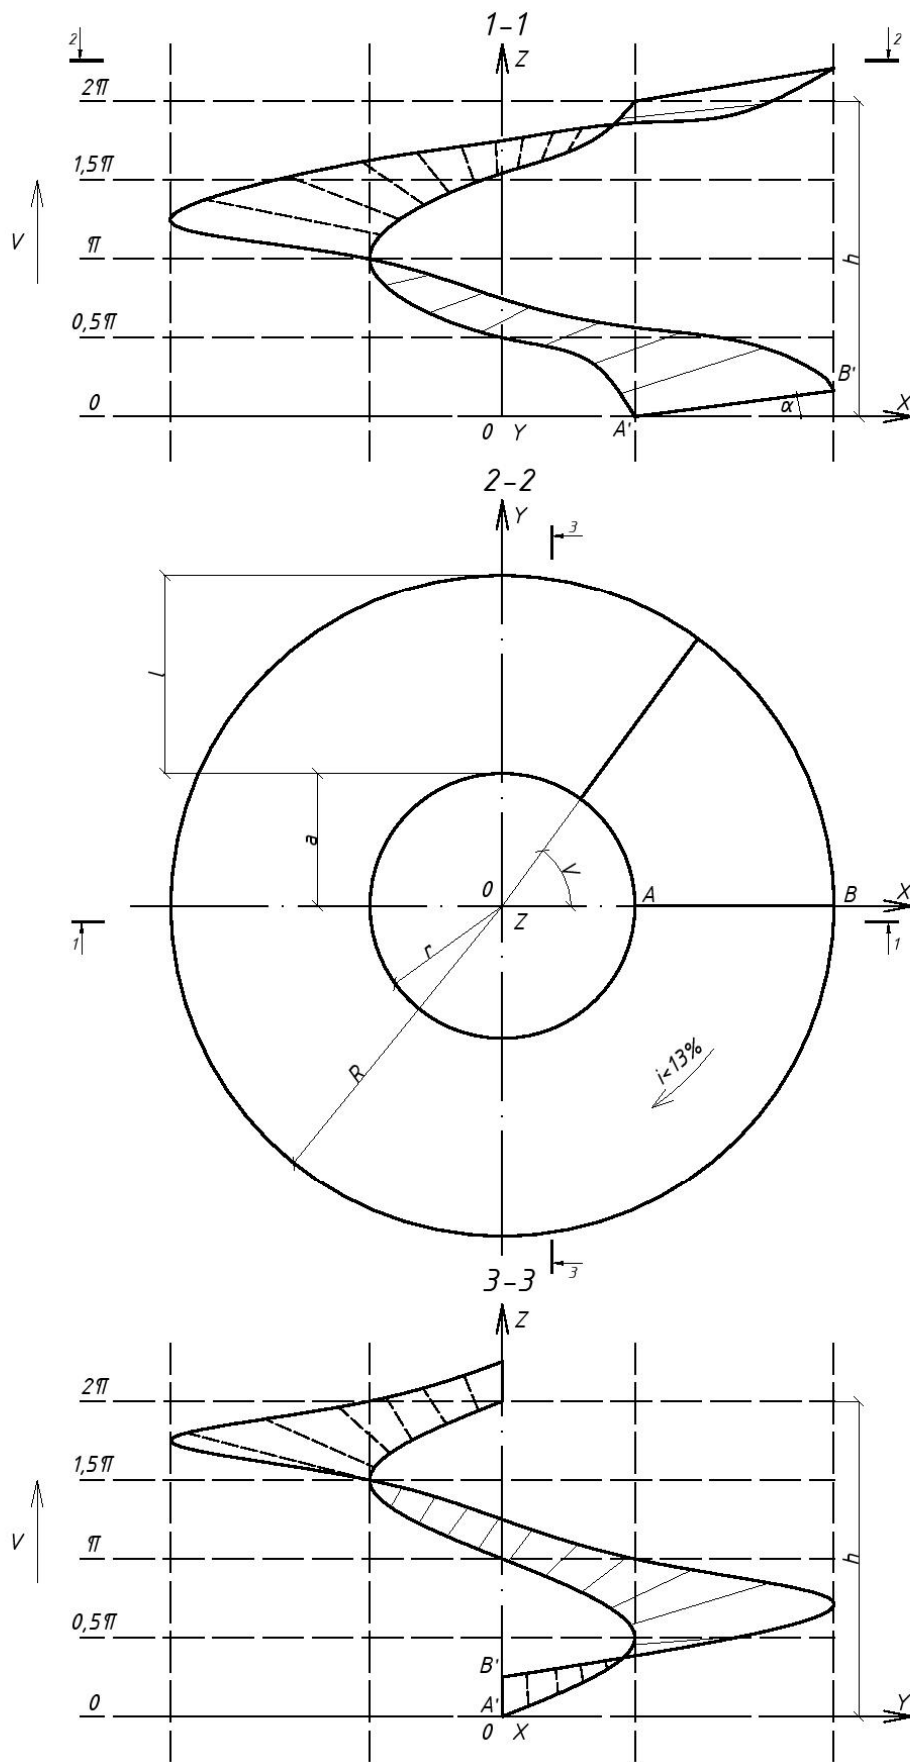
Схема утворення кругового пандуса як перекриття рампи з ухилом всередину:
